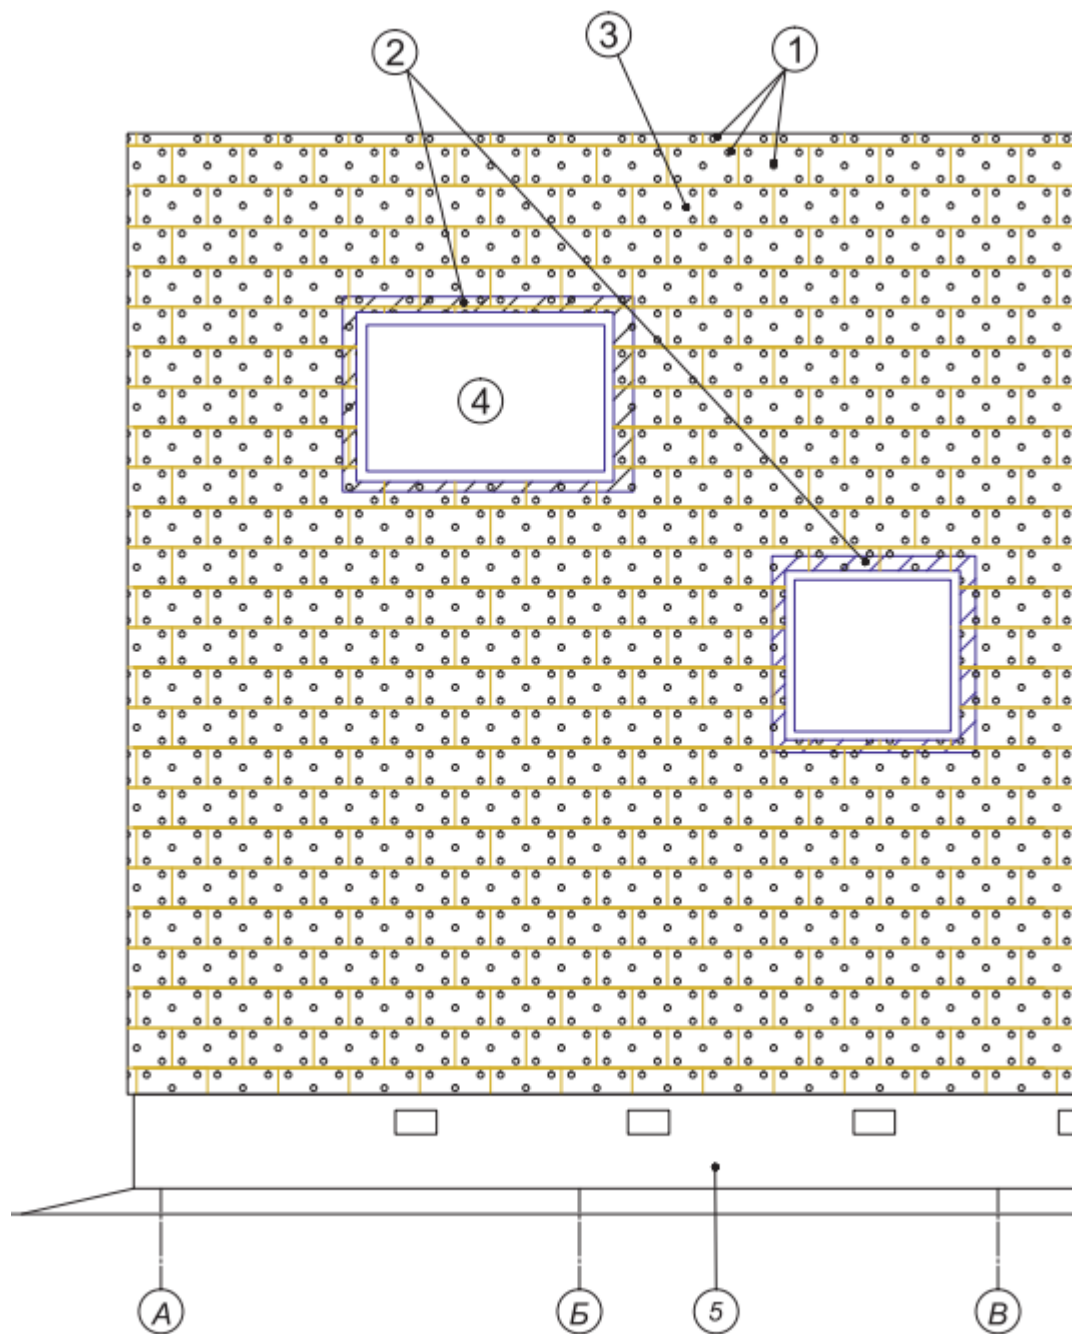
Схема монтажу утеплювача в 1 шар:
